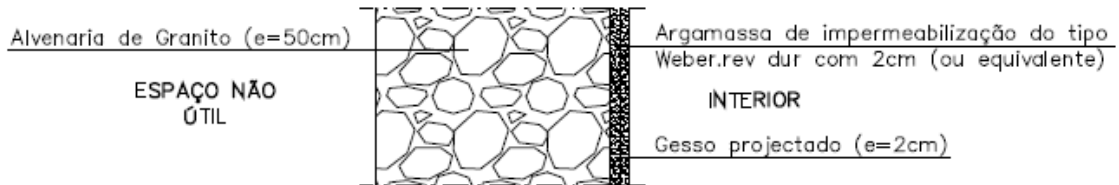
Pormenor construtivo das paredes de empena (Projeto de CT)
